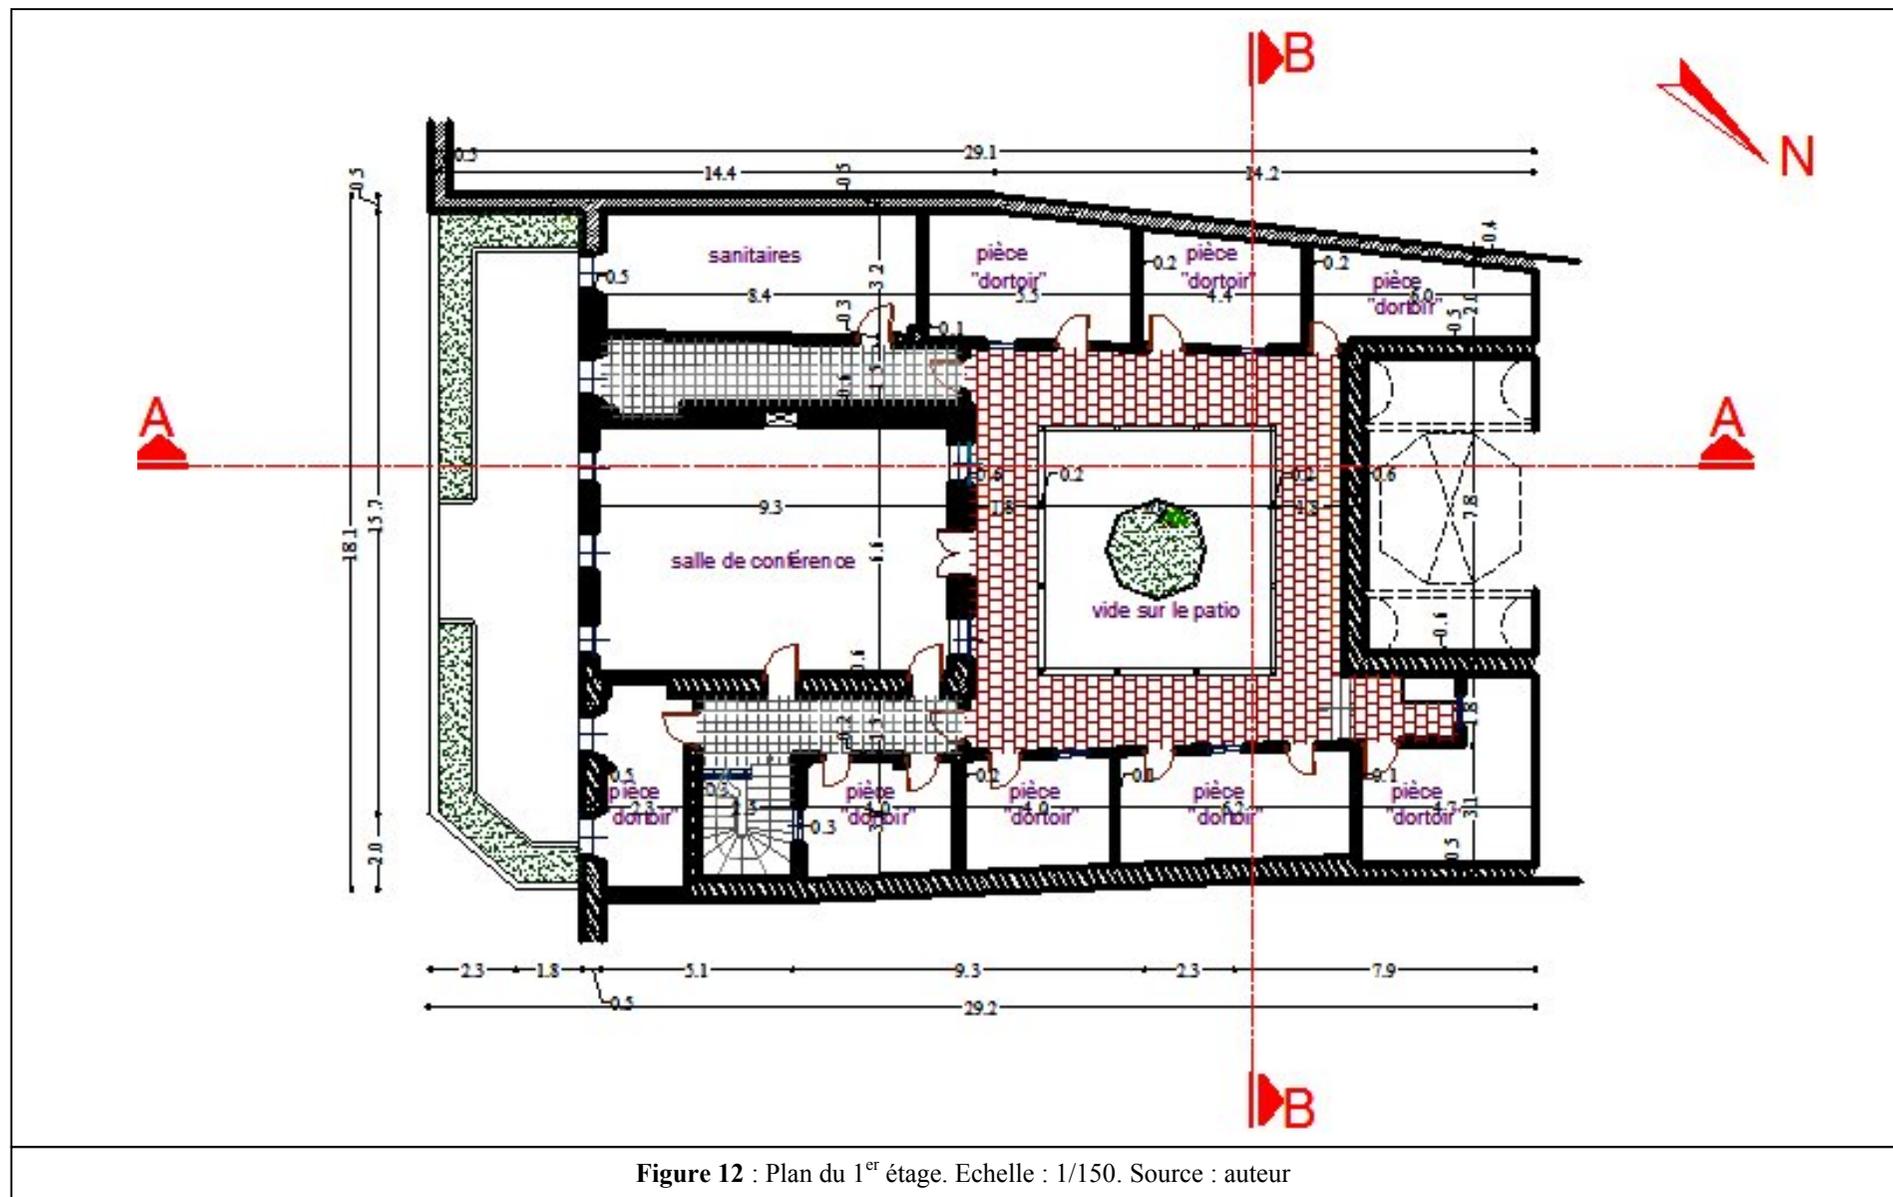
Plan du 1<sup>er</sup> étage. Echelle : 1/150. Source : auteur
